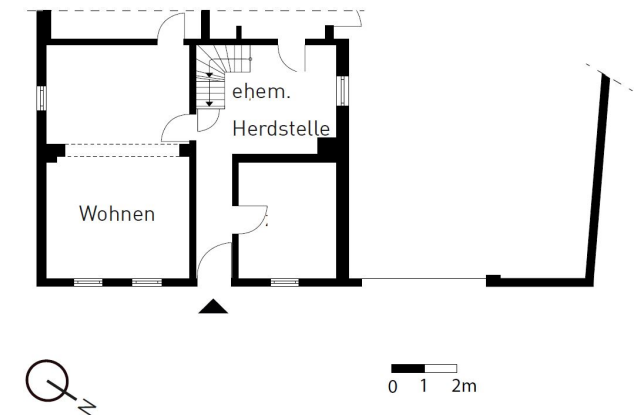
Erdgeschoss Grundriss, 2021.
